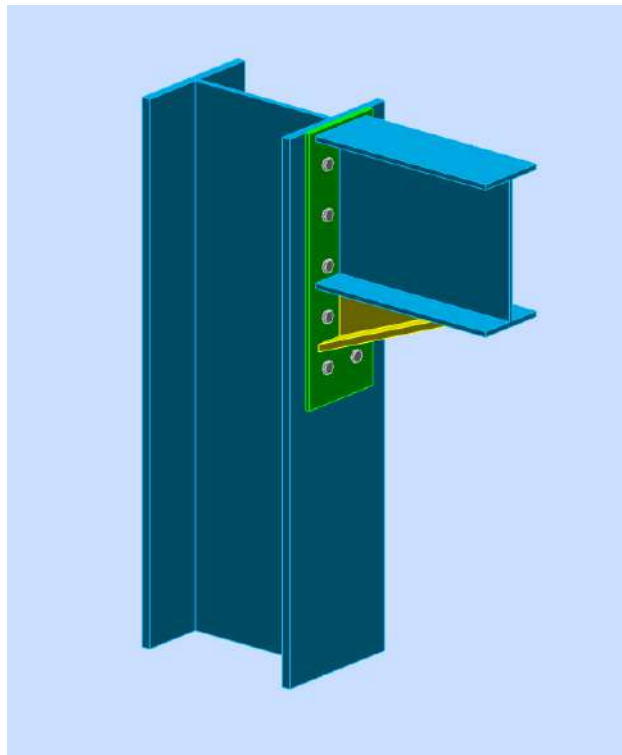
« Vue d'assemblage poteau-poutre fait par Robot »
